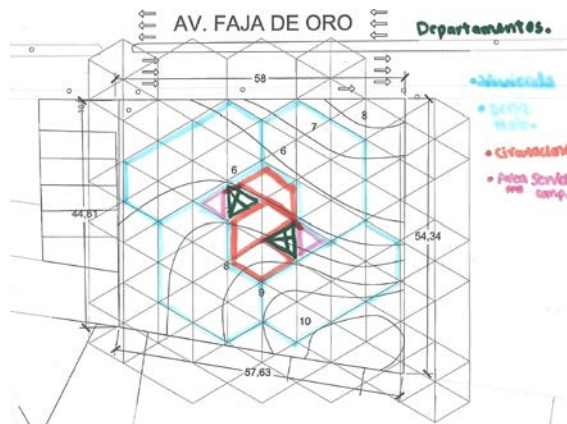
Propuesta de retícula y gasto de superficie en planta baja, del proyecto de edificio de departamentos
